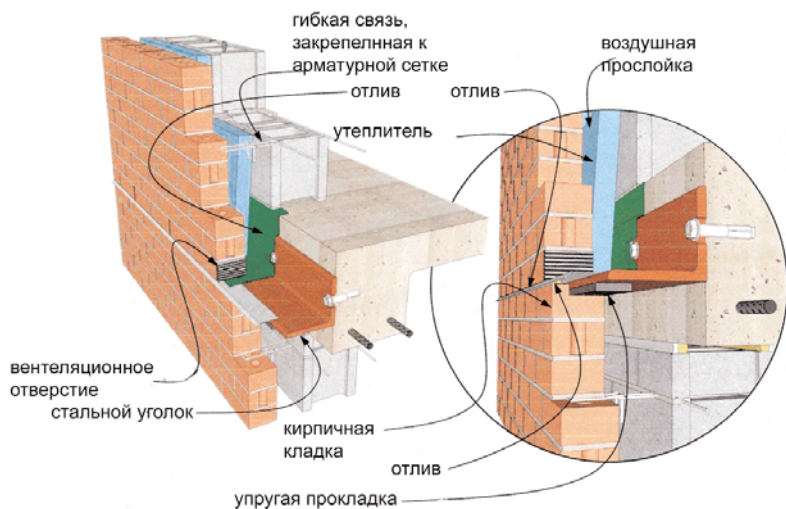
в Типичная конструкция трехслойной стены с поэтажной разрезкой [1.23]
